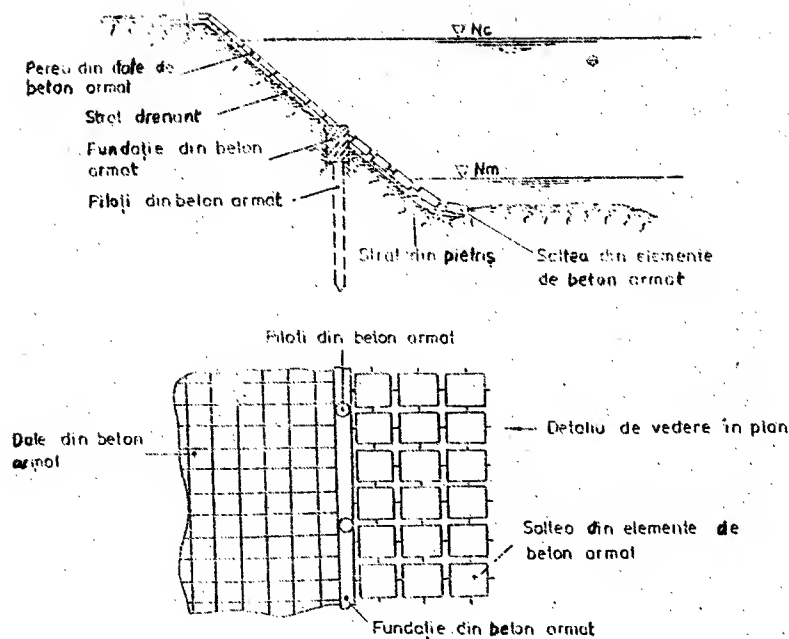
Apărare de mal cu pereu din dale de beton, piloți și saltea din elemente prefabricate din beton armat
